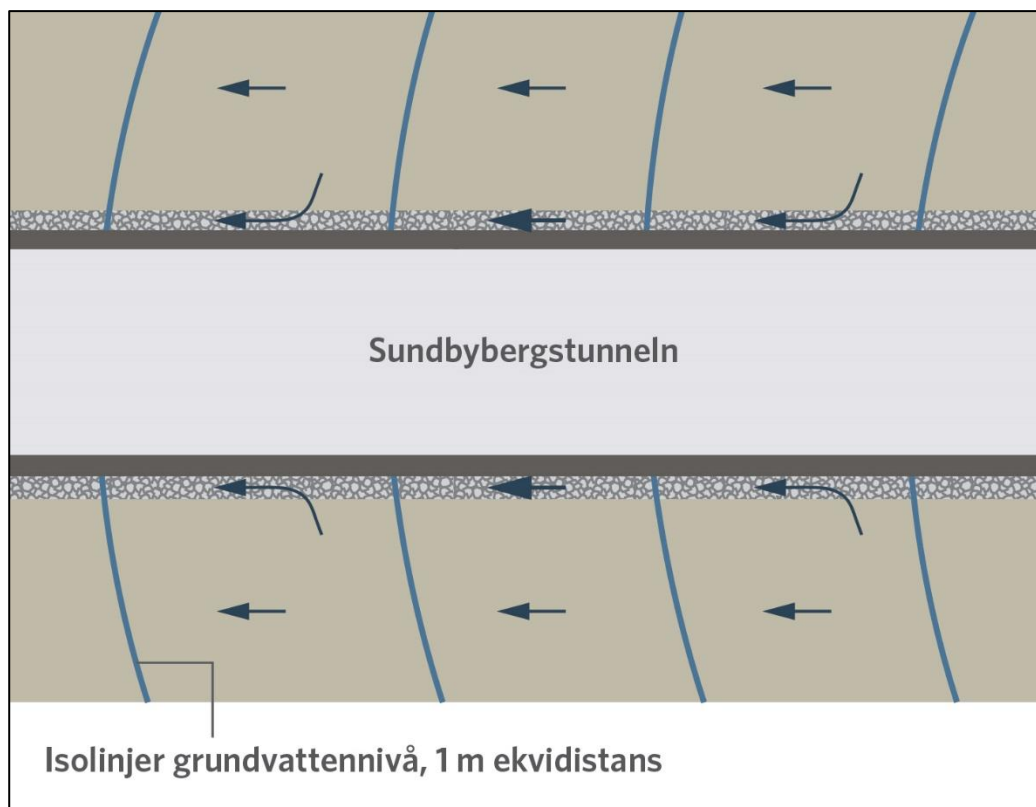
Principutformning av Sundbybergstunneln, betongtunnel med återfyllning och vid behov förankring mot upplyft. Återfyllningen medger grundvattenströmning (blåa pilar) tvärs järnvägsanläggningen i samma omfattning som innan byggnation.
